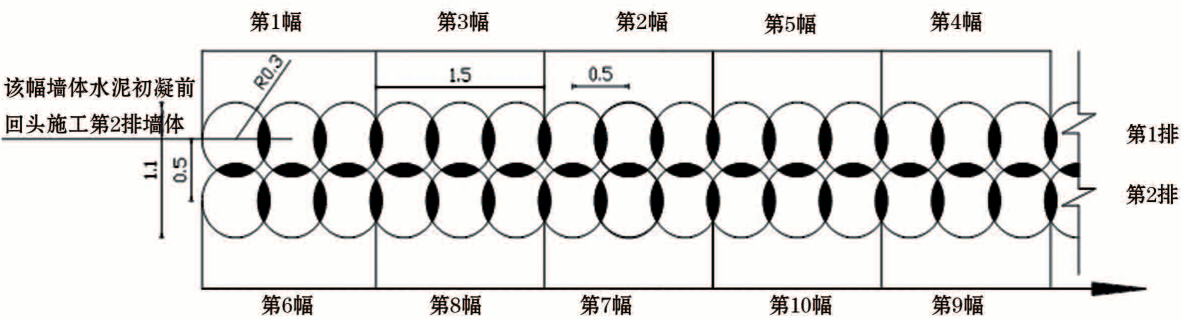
双排套打三轴搅拌桩施工顺序示意图（单位：m）
